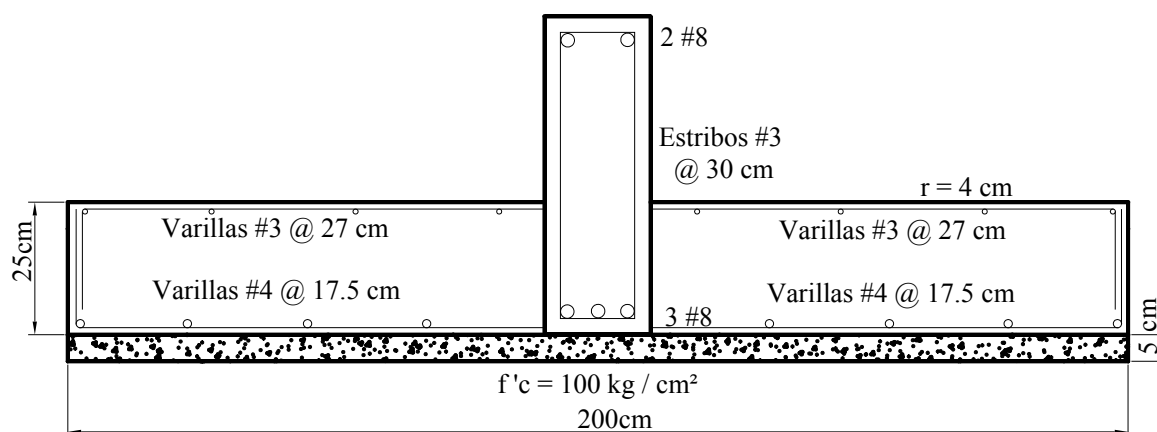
Diseño estructural de la losa y contratrabe de la zapata, caso 2.
